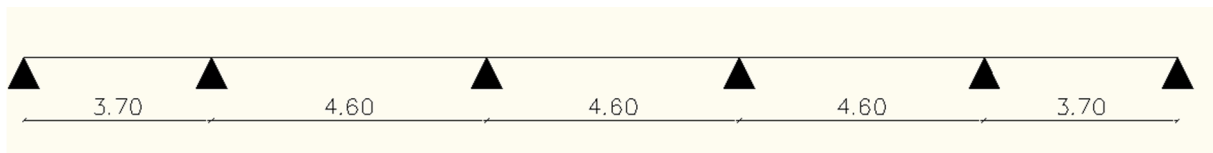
Schéma du 1^{er} type de poutrelle.
